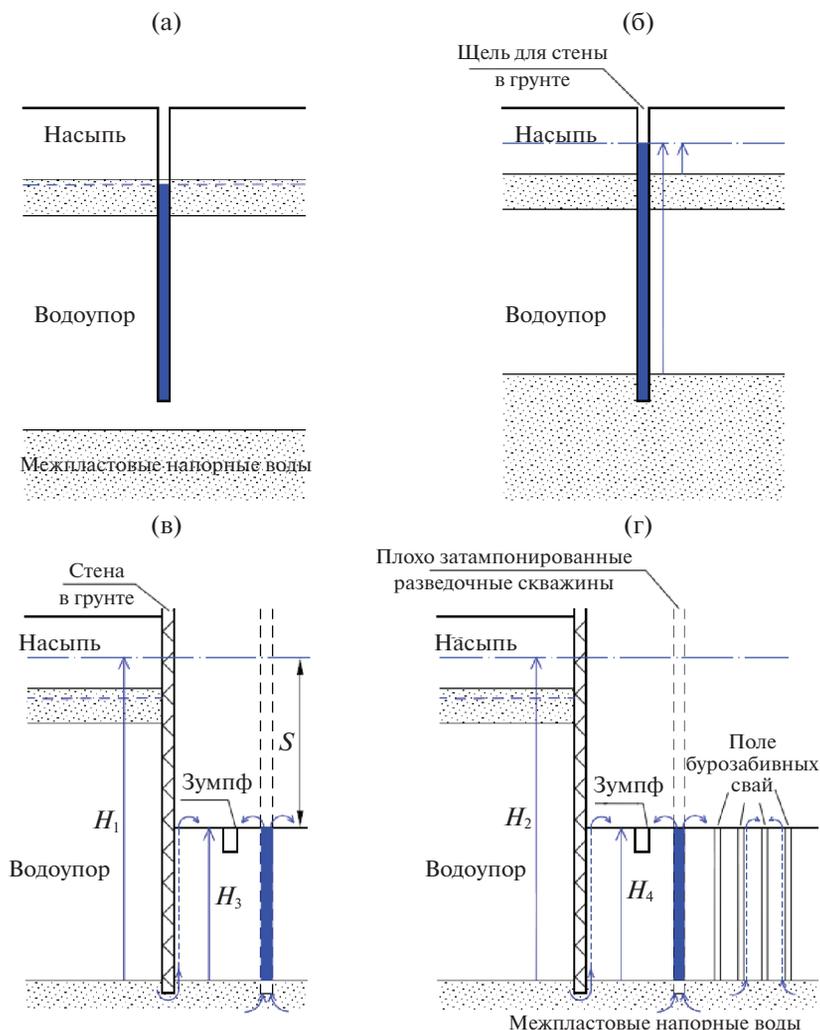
Схематическое отражение изменения гидрогеологических условий на участке в процессе строительства подземной части объекта: а – не достиг подошвы водоупора; б – вскрывает кровлю напорного водоносного горизонта; в – в период разработки котлована; г – после сооружения свайного поля под высотными корпусами здания. H_1 и H_2 – высота напора подземных вод, за пределами “стены в грунте” при работающем насосе в зумпфе; H_3 и H_4 – высота напора подземных вод на момент включения и выключения насоса в зумпфе; S – величина водопонижения.
